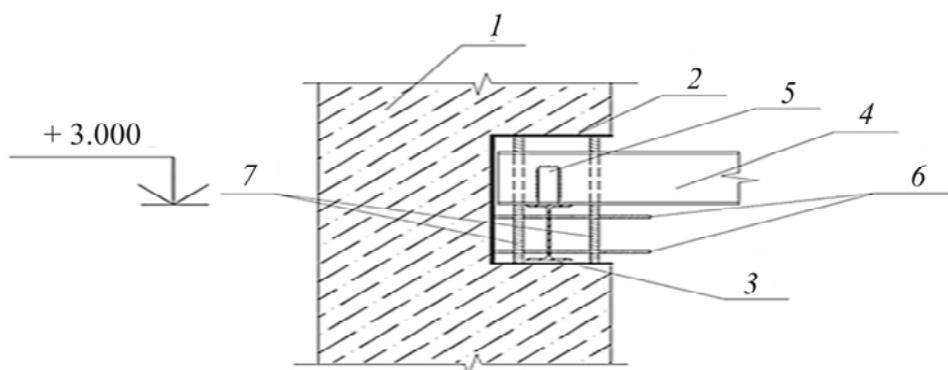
Сопряжение двутавровой балки с «монтажным гнездом» при монолитном исполнении стены: 1 — монолитная стена; 2 — оставленная при бетонировании ниша; 3 — двутавровая балка, подобранная по условию $h \geq h_n$, где h — высота двутавра, h_n — высота перекрытия; 4 — поперечная двутавровая балка на ширину пролета; 5 — раскос для устойчивости поперечной двутавровой балки; 6 — выпуски арматуры в монолитной стене, предусмотренные по предварительному расчету; 7 — продольные вертикальные арматурные стержни монолитной стены
